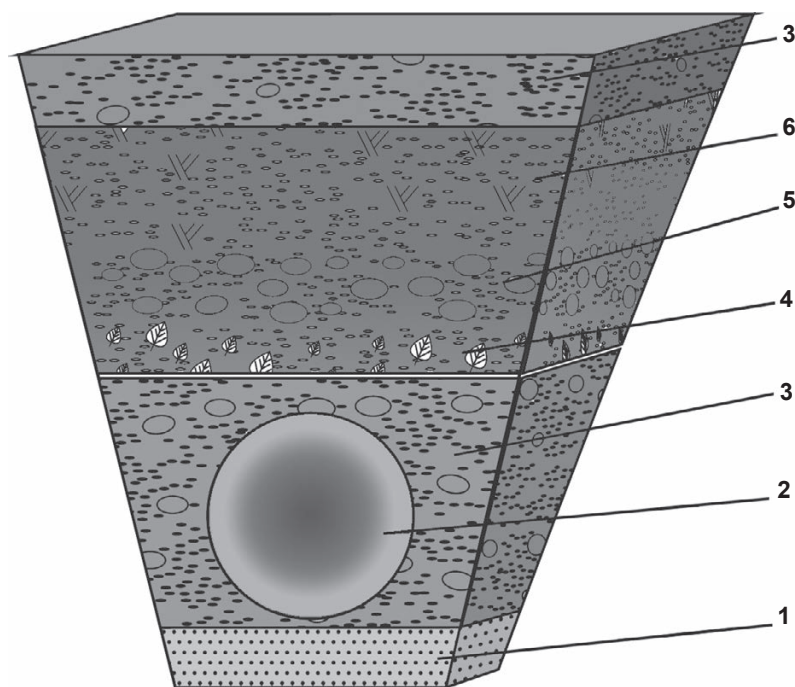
Утепление подземного водопровода: 1 — песчаная подушка; 2 — труба; 3 — грунт; 4 — сухие листья; 5 — опилки; 6 — торф
